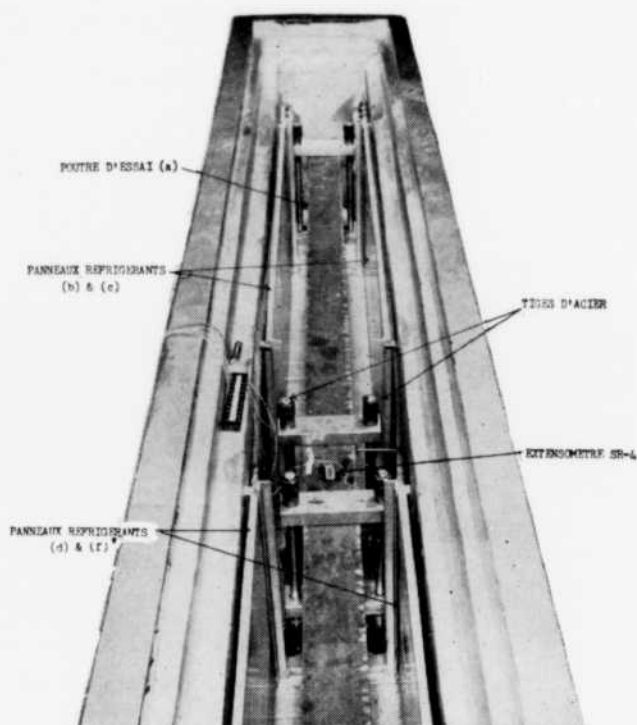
Boîte réfrigérante contenant une poutre d'essai.
